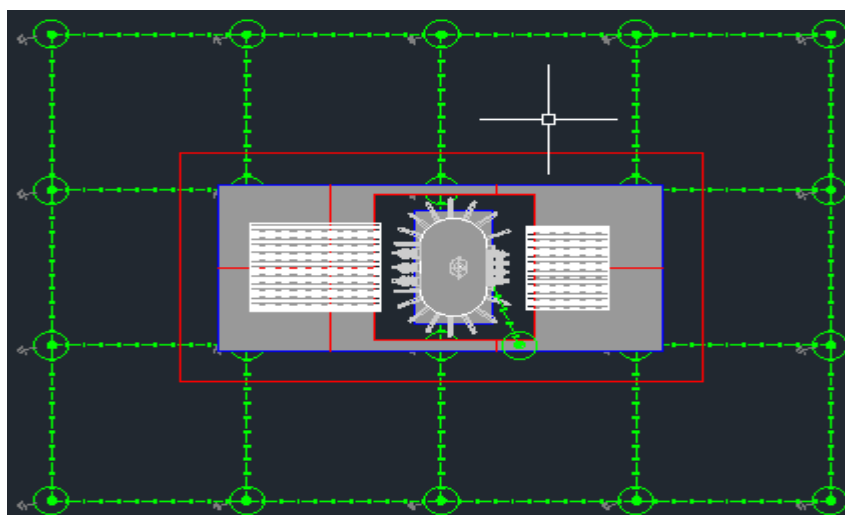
Desenho da Malha de terra para a Subestação elevadora
